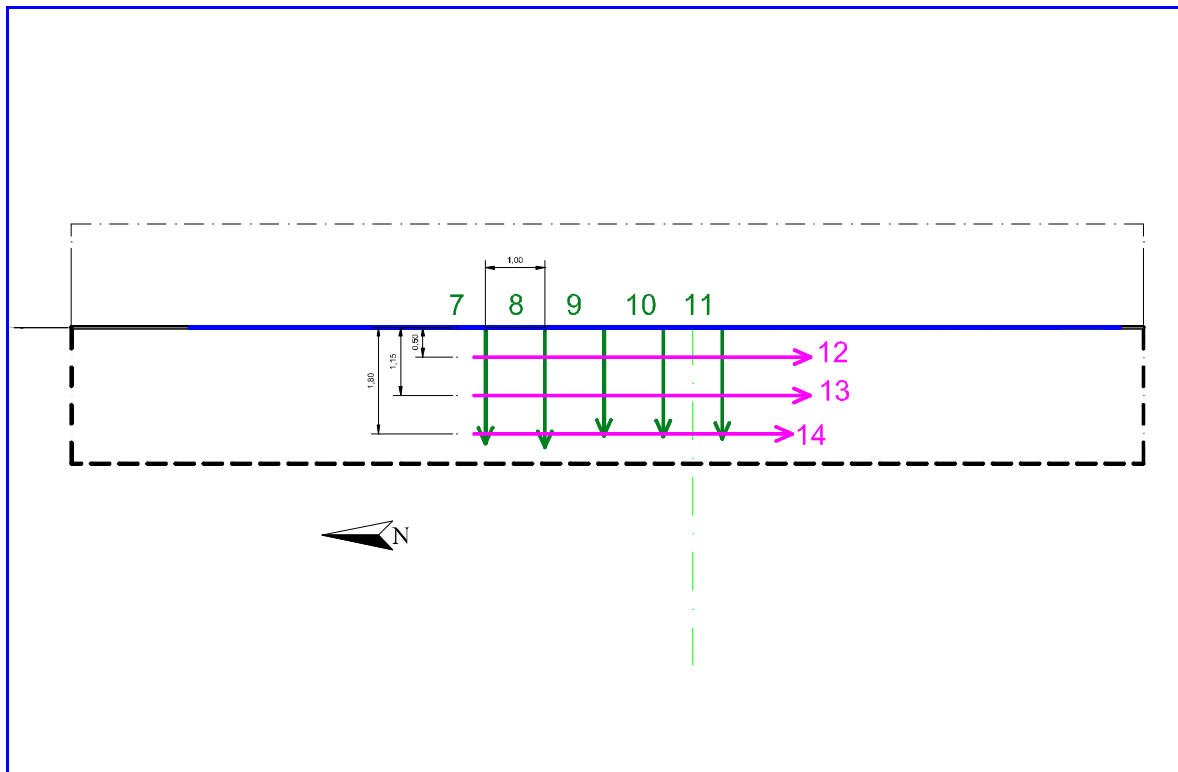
SP 34C - km 0+300 - Prospetto dell'area di prova
